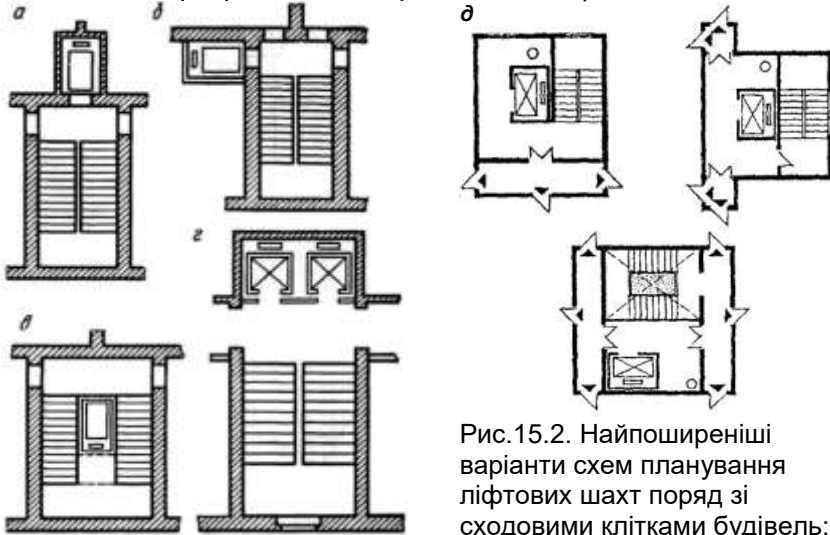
Найпоширеніші варіанти схем планування ліфтових шахт поряд зі сходовими клітками будівель:
